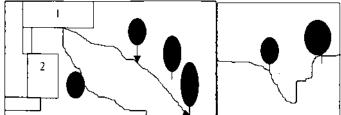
Схема предполагаемого размещения дома: 1 — первоначальный проект, 2 — окончательная площадка размещения
